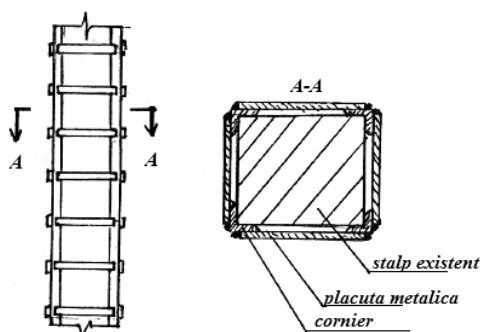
Consolidarea stâlpilor din beton armat cu profile metalice [97]
